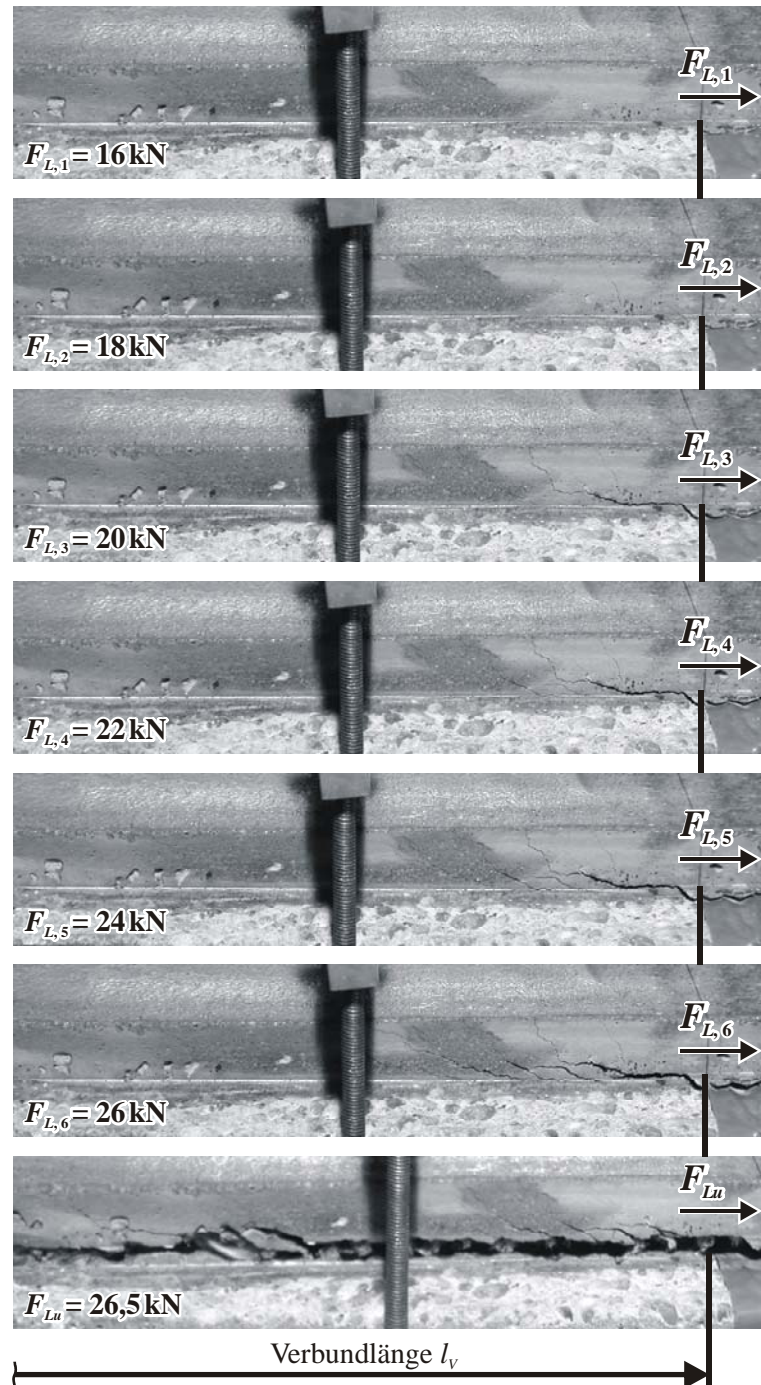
Schräg- und Verbundrissbildung für sieben ausgewählte Laststufen bis zum Bruch durch Delaminationsversagen
